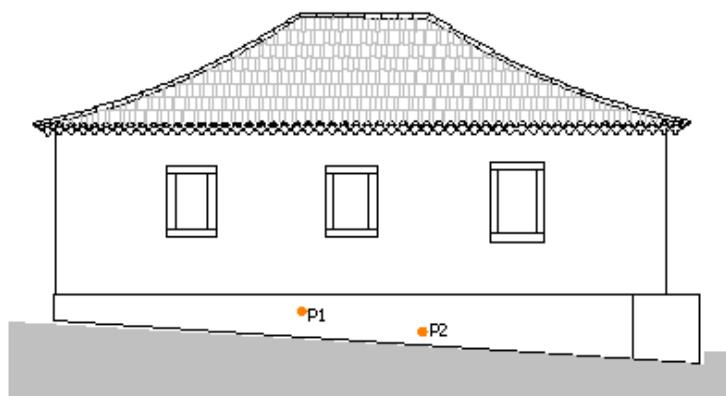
Pontos 1 e 2 da Fachada Lateral.
